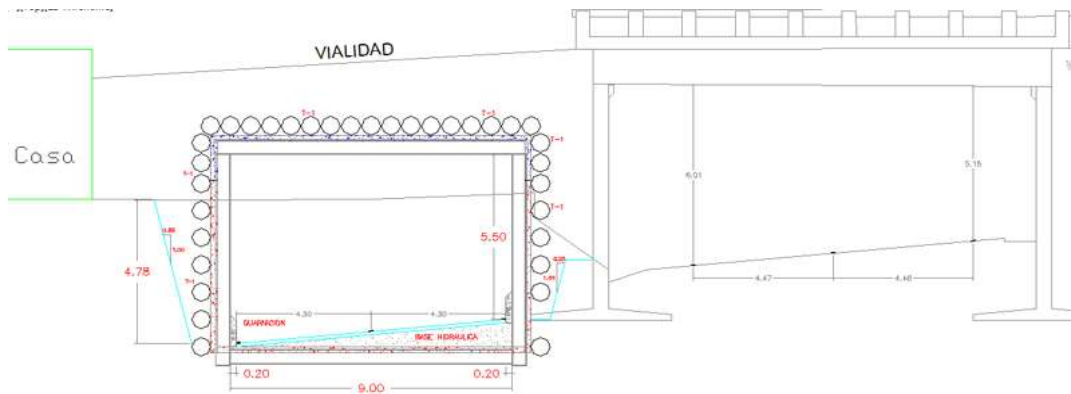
Corte B-B' (Vista Ixtapan-Tenango)
